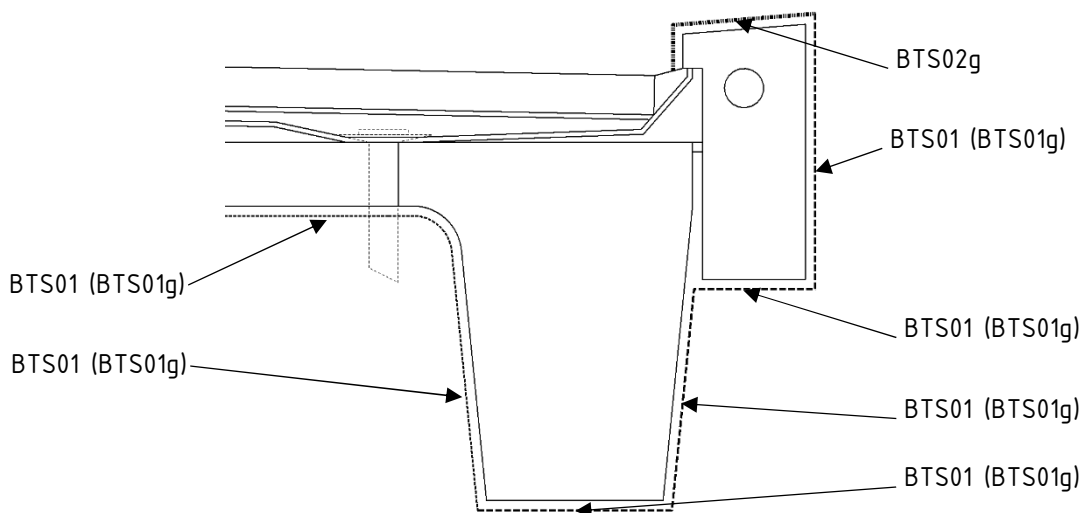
paveikslas 8 Betono apsaugos būdų vietas sienoms (atramoms)
